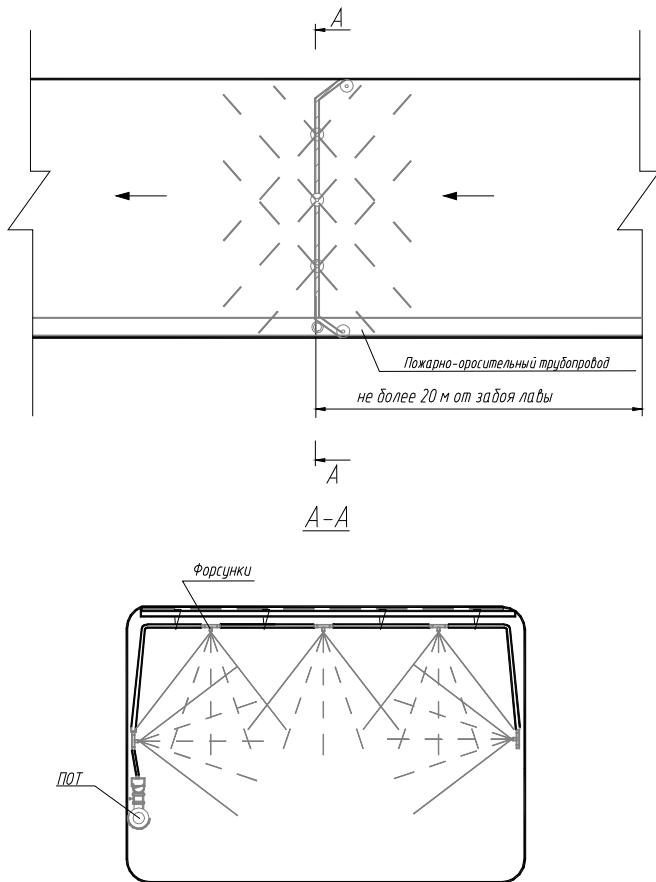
Схема установки водяной завесы (где ПОТ – пожарно-оросительный трубопровод)
